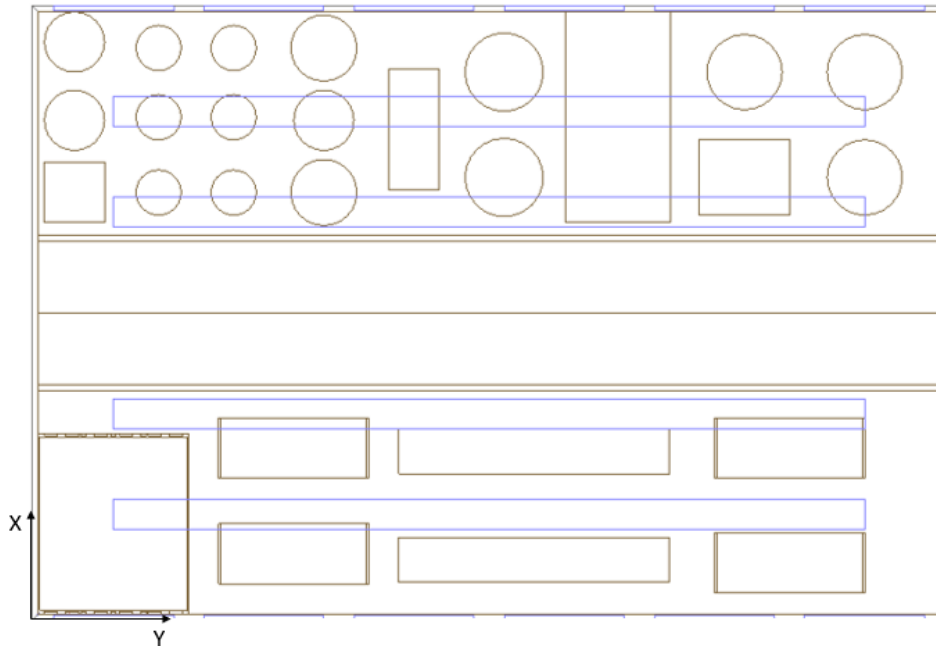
Vista de la planta de la nave industrial, propuesta 3. Fuente DIALux.
